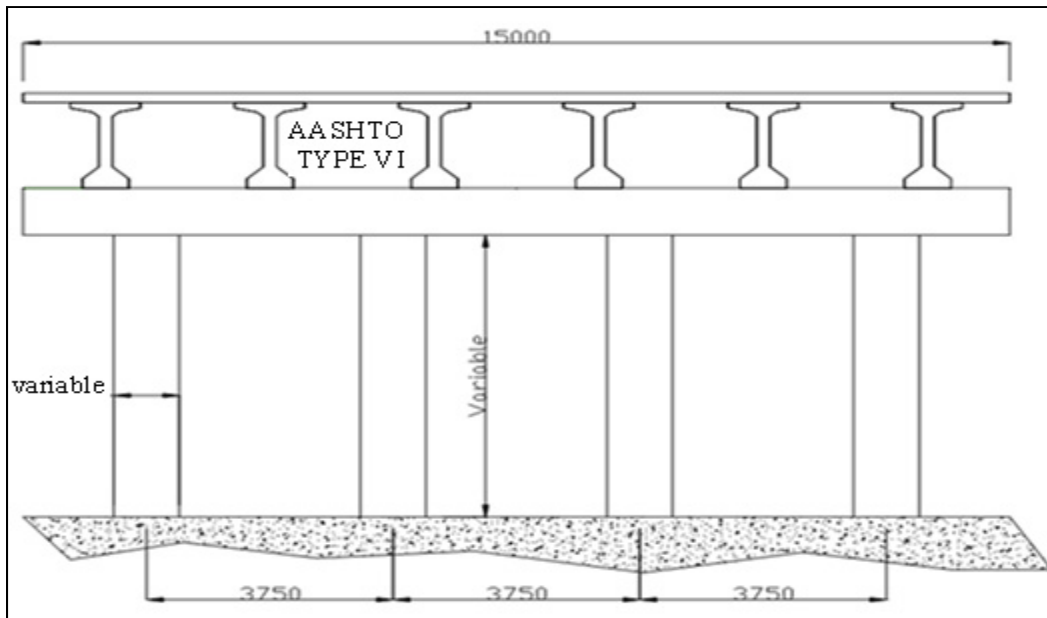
Coupe transversale de l'ouvrage au niveau de la pile
